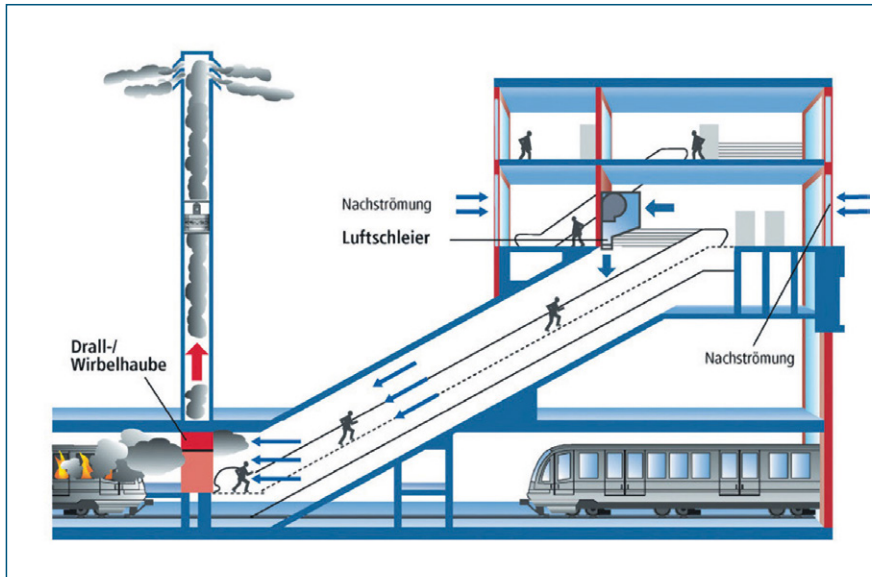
Rolltreppenschacht mit Luftschleier und Wirbelhaube
